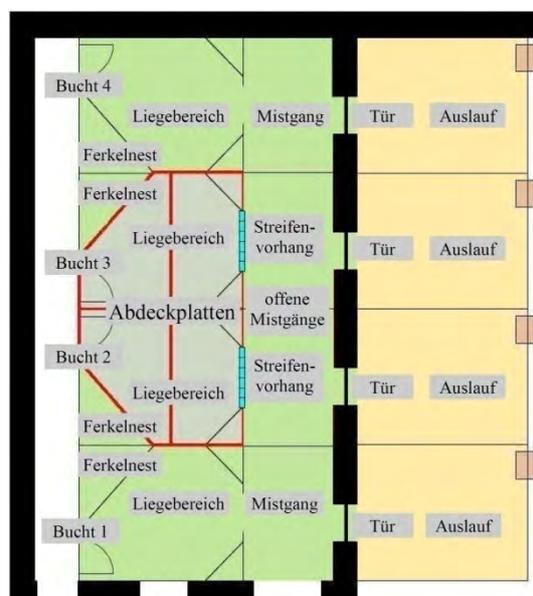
Grundrissdarstellung des 2. Versuchsaufbaus mit abgedeckten Liegebereichen und offenen Mistgängen
